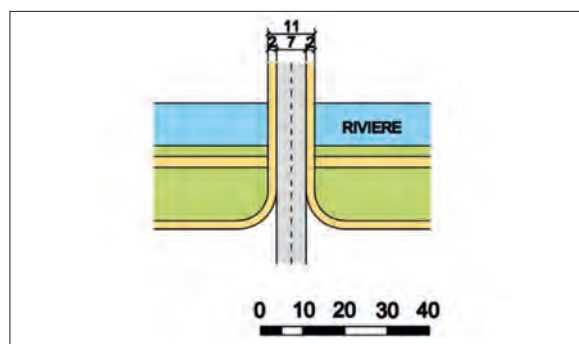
Plan pour le cas N° 21 : Passage sous pont (les récepteurs sont à 5 - 1,5 = 3,5 m sous le plan de roulement)
